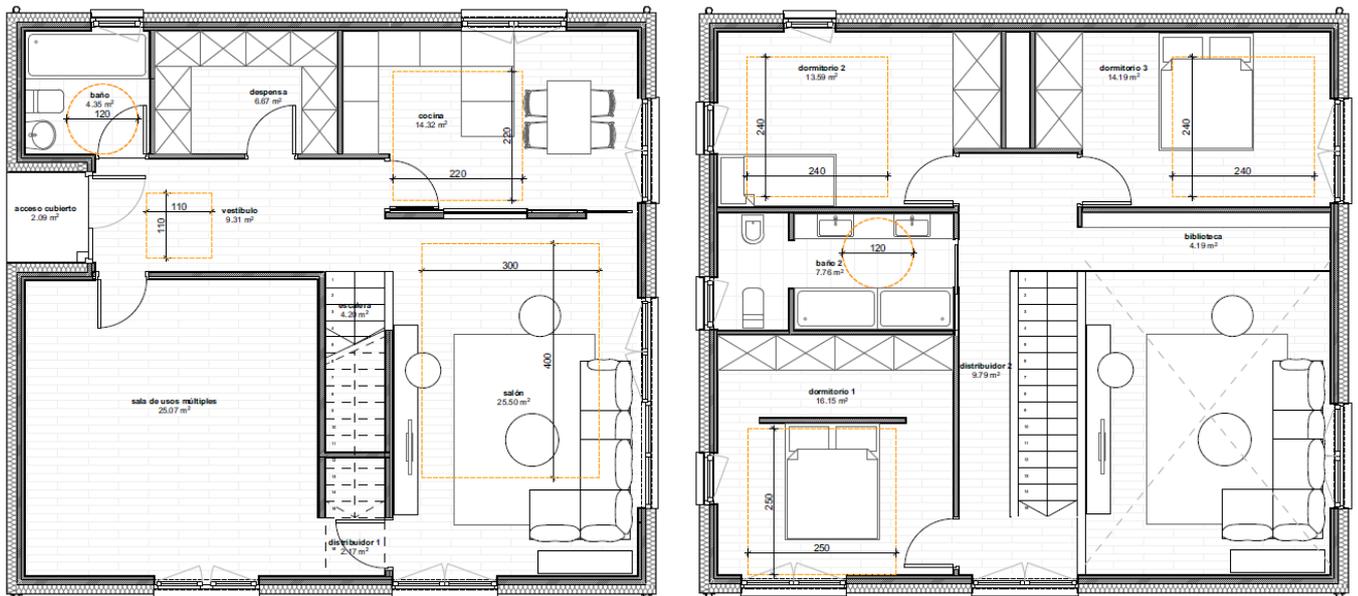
Planta baja (izquierda) y Planta primera (derecha)
